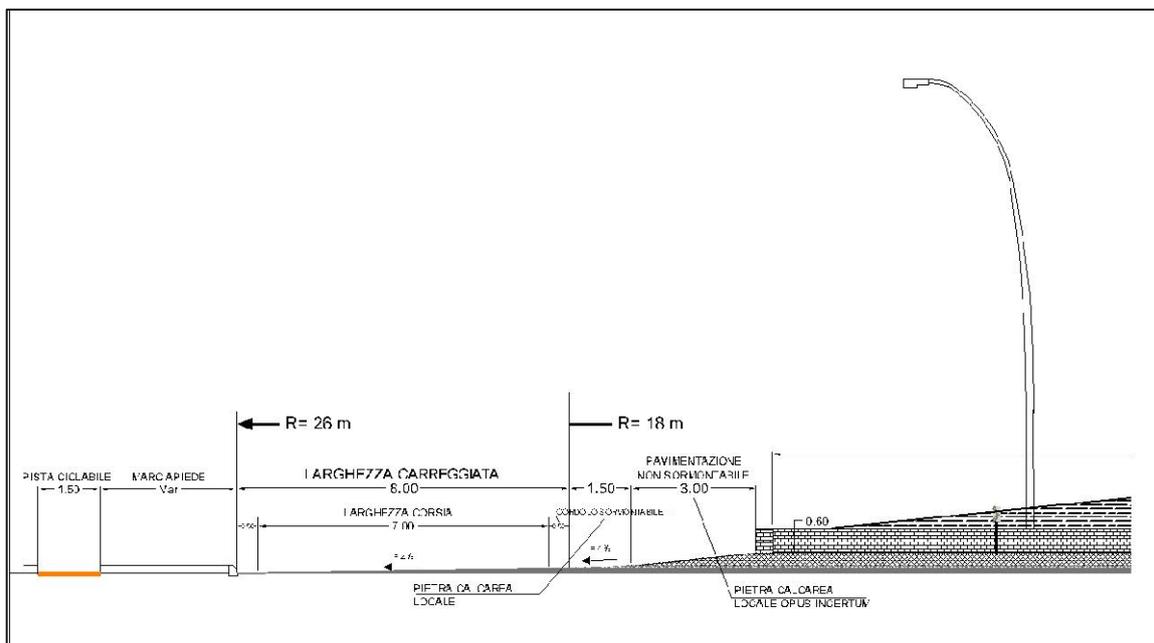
d Sistemazione tipo svincolo regolato da rotonda nel progetto esecutivo - Sezione
